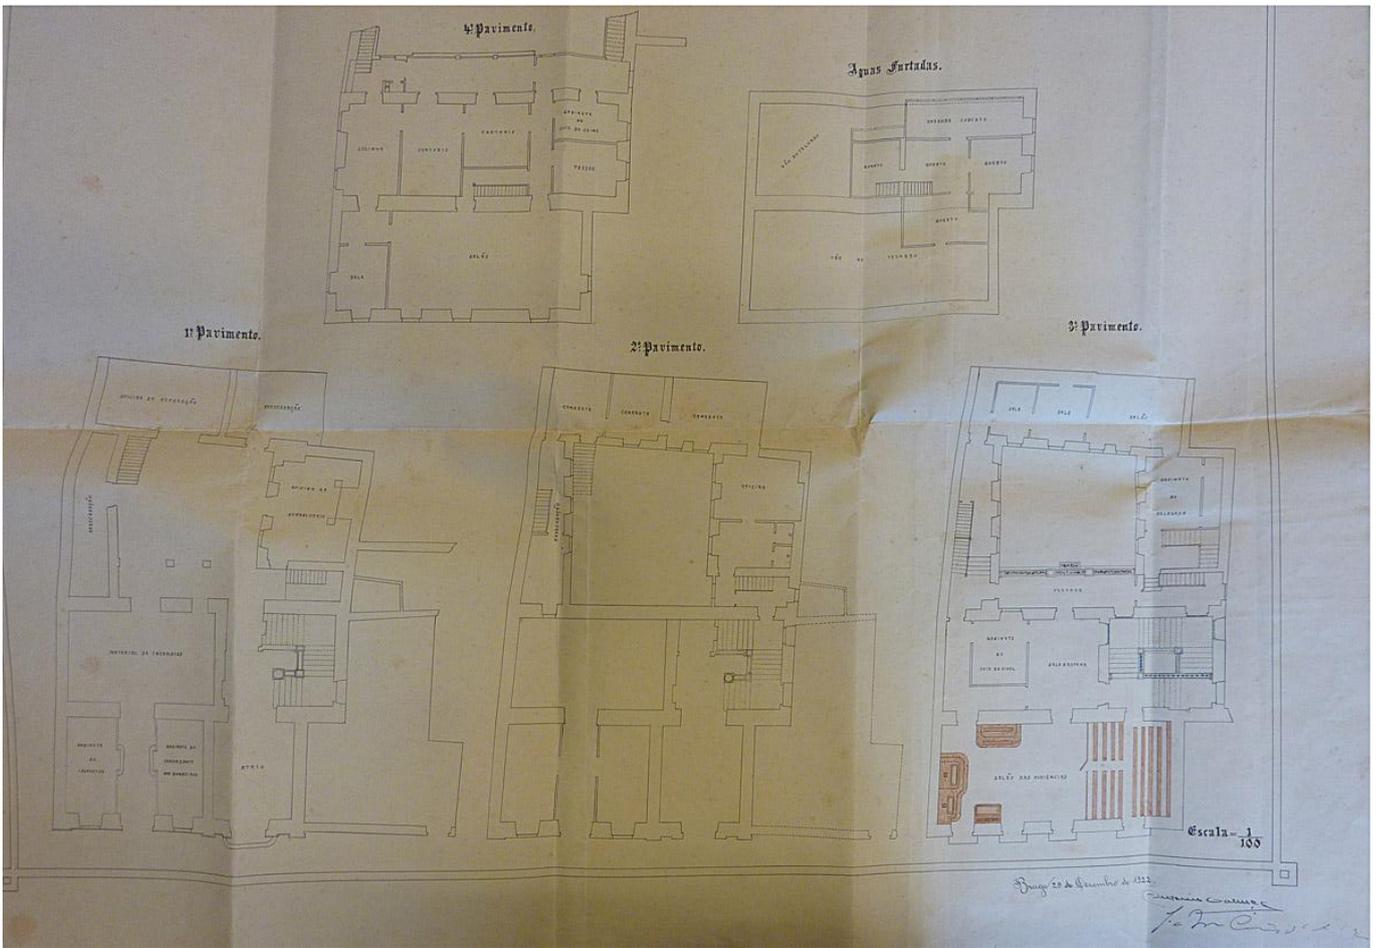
Ilustração XXI | Planta de levantamento do existente Tribunal Judicial de Braga
